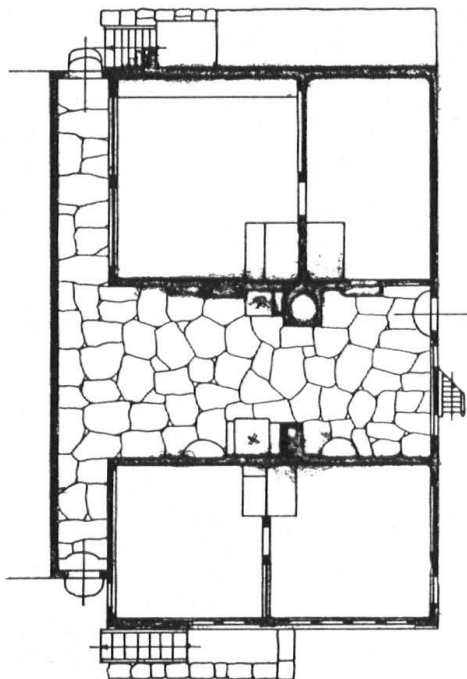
Grundriss zum Haus Gerber in Rünkhofen. — Fig. 7. Plan de la maison Gerber à Rünkhofen.
